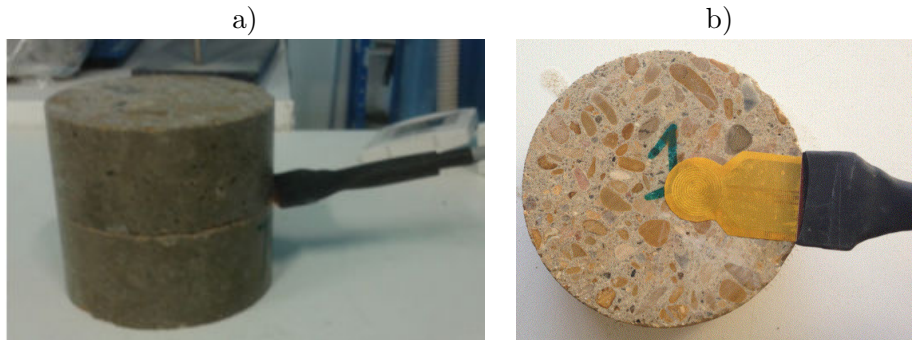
a) deux éprouvettes entourent la sonde b) éprouvette et sonde.
